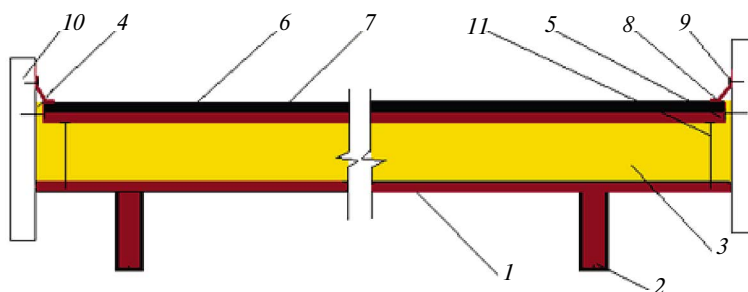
Схема «плавающего» пола по лагам: 1 – сплошное основание; 2 – лаги; 3 – теплоизоляционный слой из рулонного НПЭ; 4 – участок единого теплоизоляционного полотна, примыкающего к стенам; 5 – крепление теплоизоляции к основанию; 6 – несущее покрытие пола (сборная стяжка, основание); 7 – финишное покрытие пола; 8 – плинтус; 9 – крепление плинтуса; 10 – стена; 11 – крепление теплоизоляции к основанию
